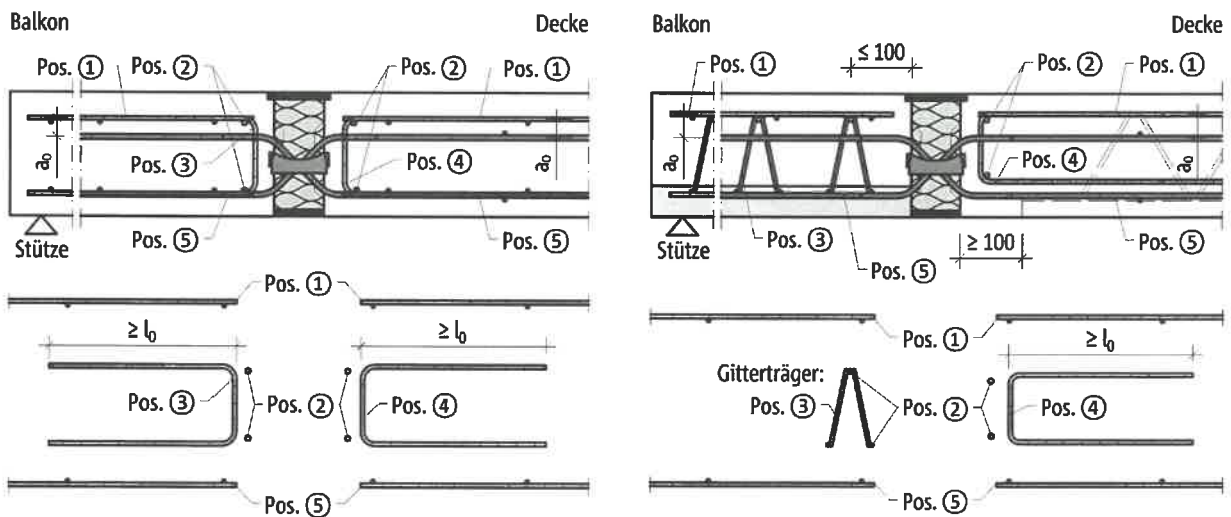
Schöck Isokorb® T Typ Q-VV6 bis -VV12 6.0, indirekte Lagerung: Bauseitige Bewehrung bei Ortbetonbauweise (links) und Fertigteilbauweise (rechts) schematisch dargestellt
